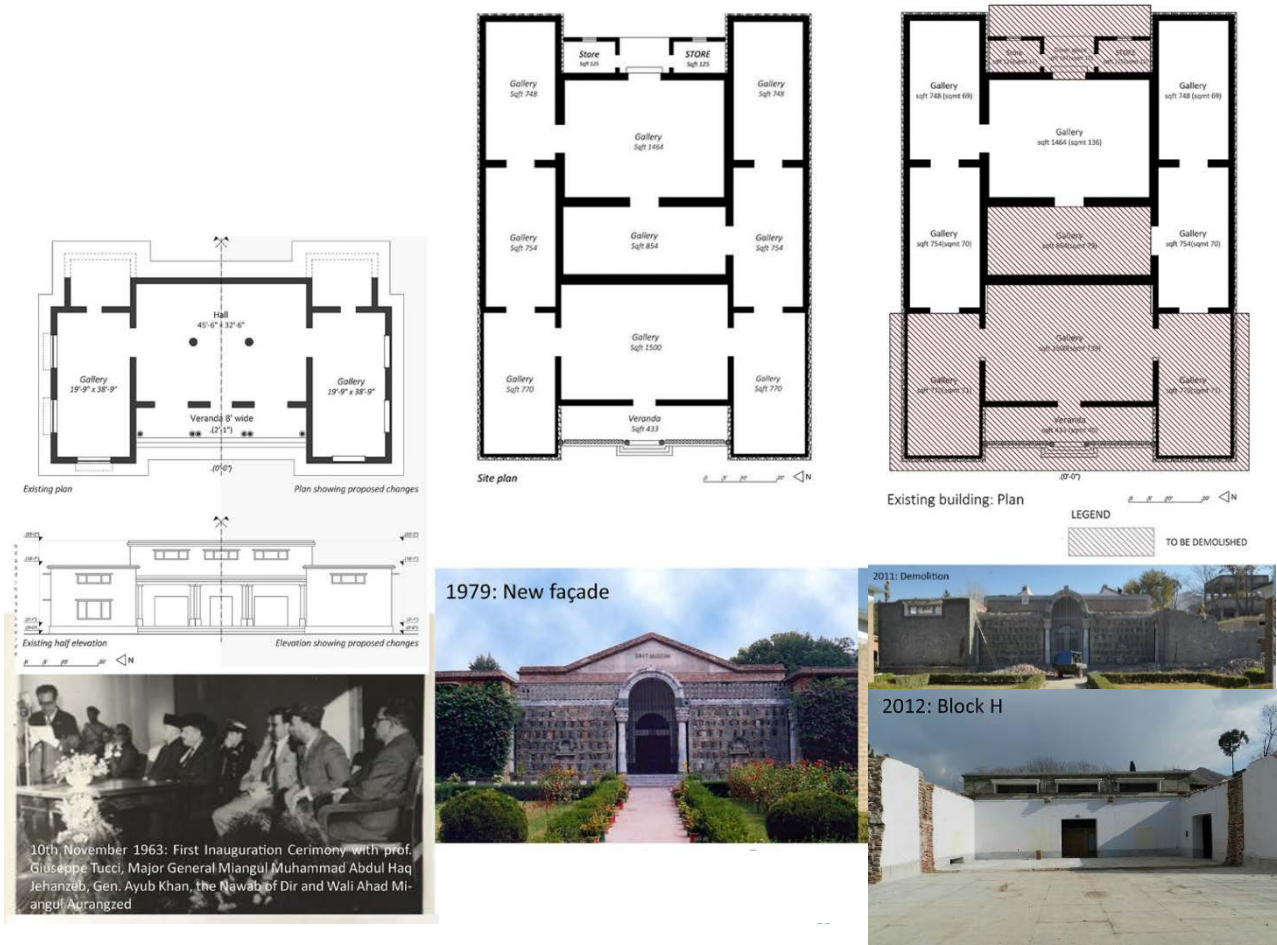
Swat Museum – Pianta, prospetti, viste dal 1959 al 2012
